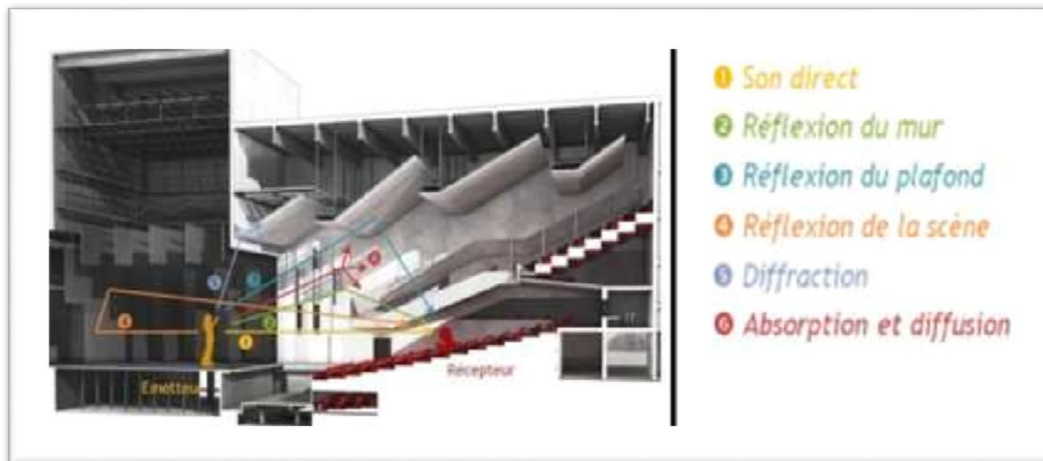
Coupe longitudinale dans une salle de cinéma avec un plafond en escalier.
